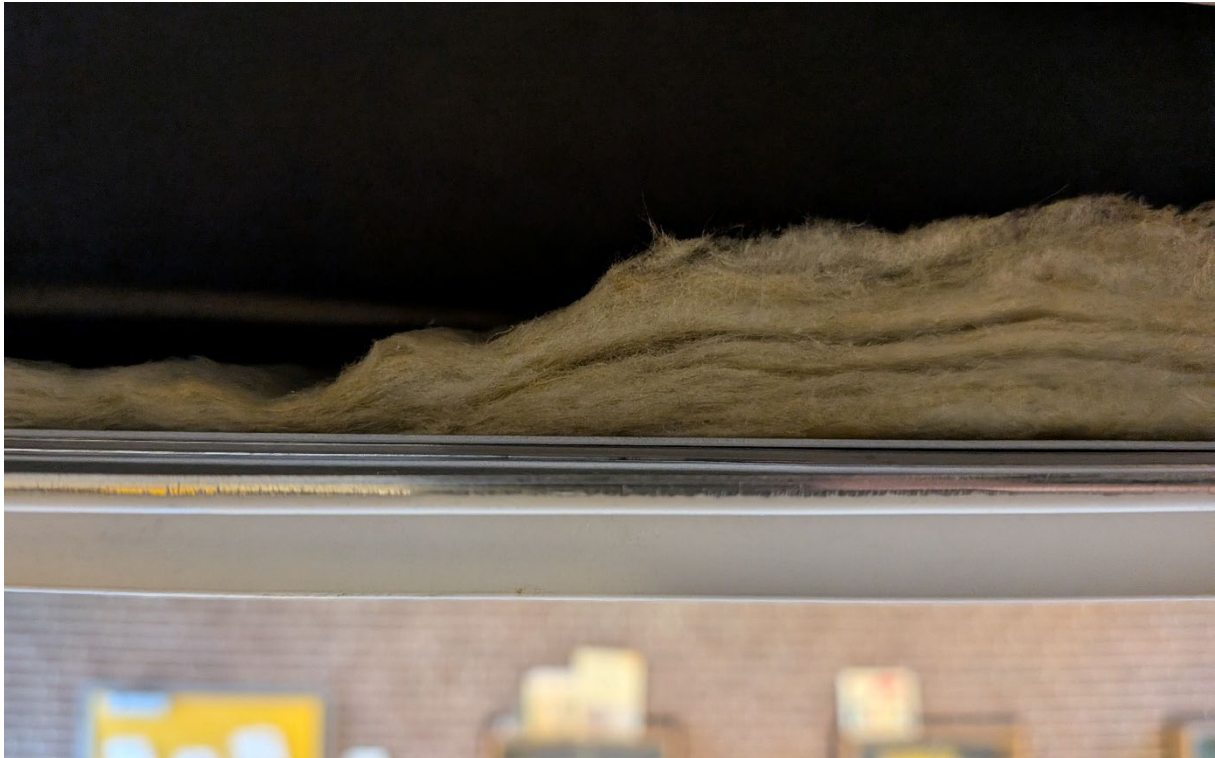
KMF-haltige lose Deckenauflage der Abhangdecken in Trakt A und B im EG und in Trakt B und D im 1. OG
